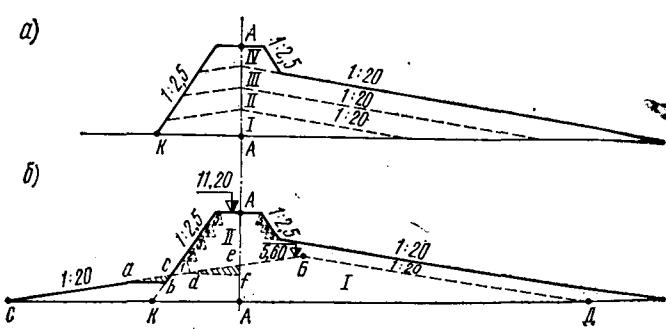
Проектный поперечник насыпи (а) и сечение возводимой насыпи (б)
